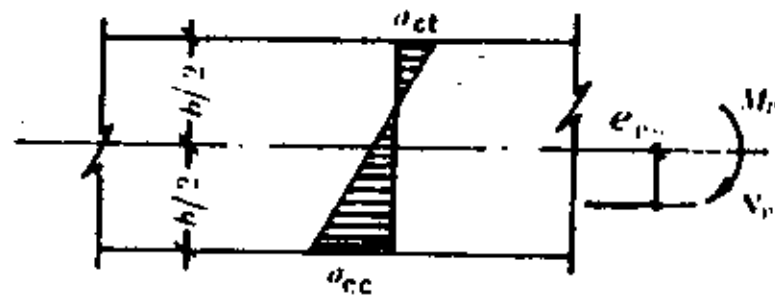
预应力混凝土 V 形折板施工阶段中纵向计算简图
